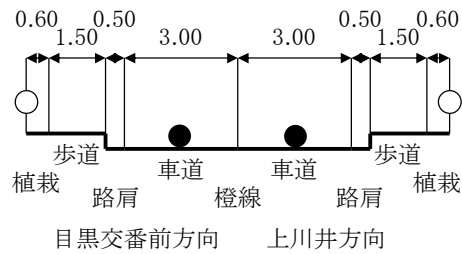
(3) 道路断面及び音源の位置 (No. 3)
